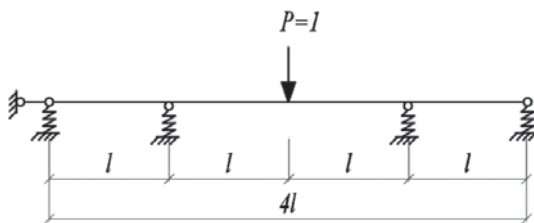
Расчетная схема подкрановой балки для определения жесткости упругоподатливой опоры
